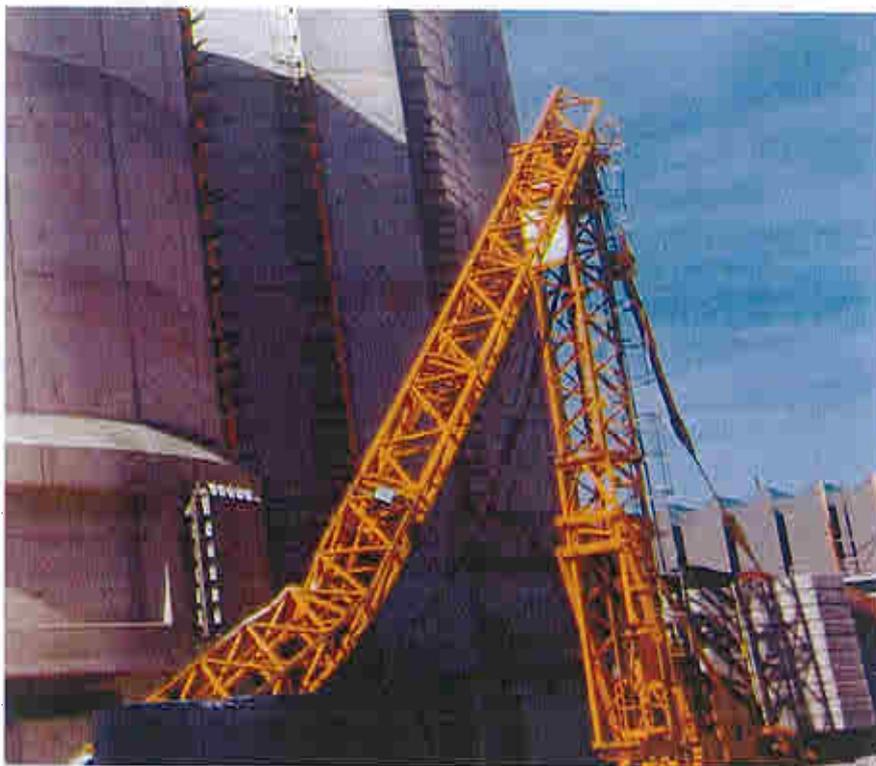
Vue d'ensemble de la grue depuis l'Est
